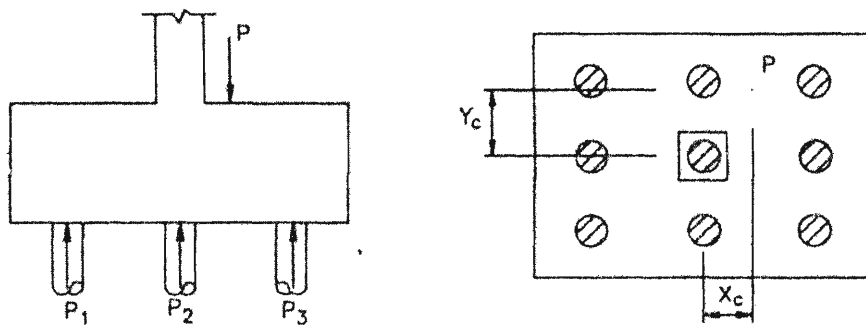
Zapata sobre pilotes sometida a carga excéntrica
